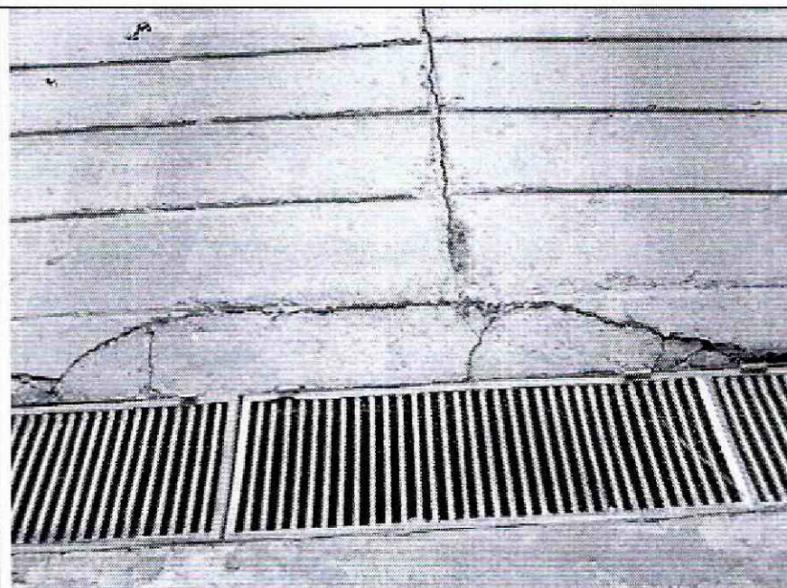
Grieta en cárcamo de la rampa de acceso.
